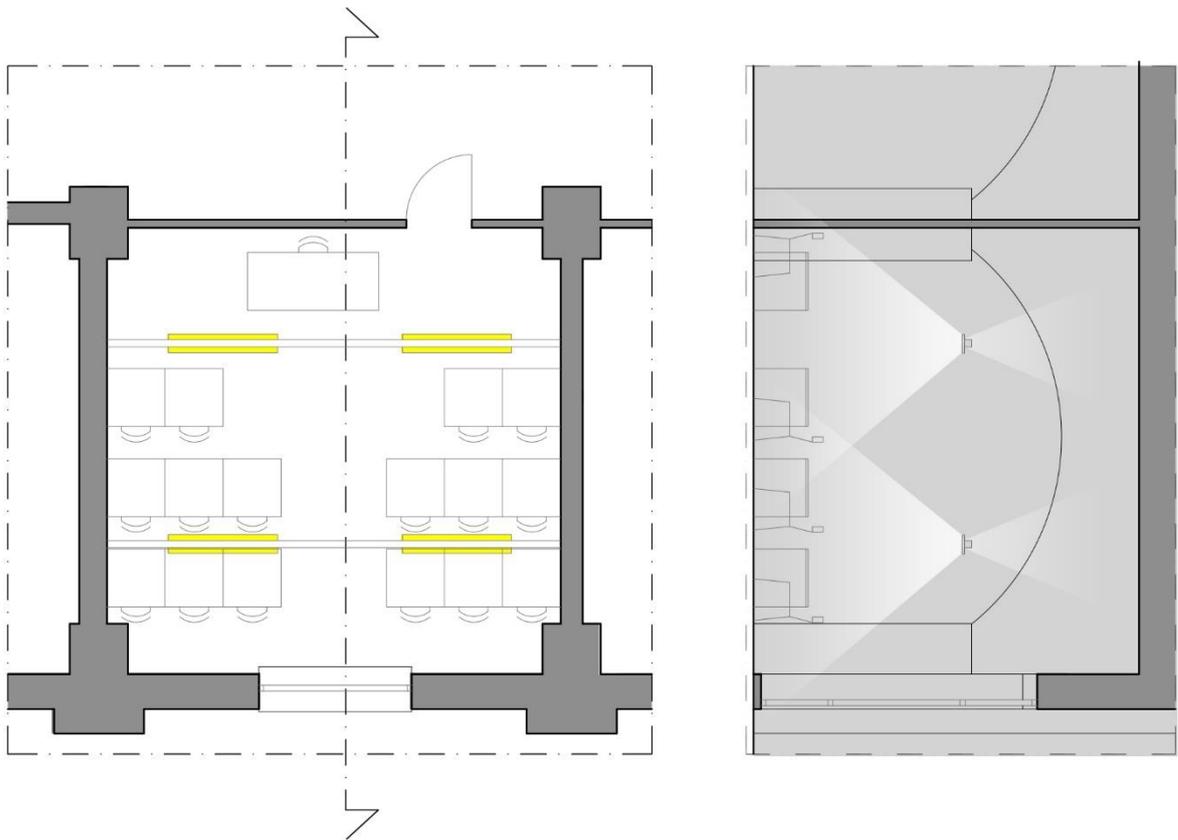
Pianta e sezione fuori scala dell'aula tipologia 2 con disposizione dei banchi e degli apparecchi.
